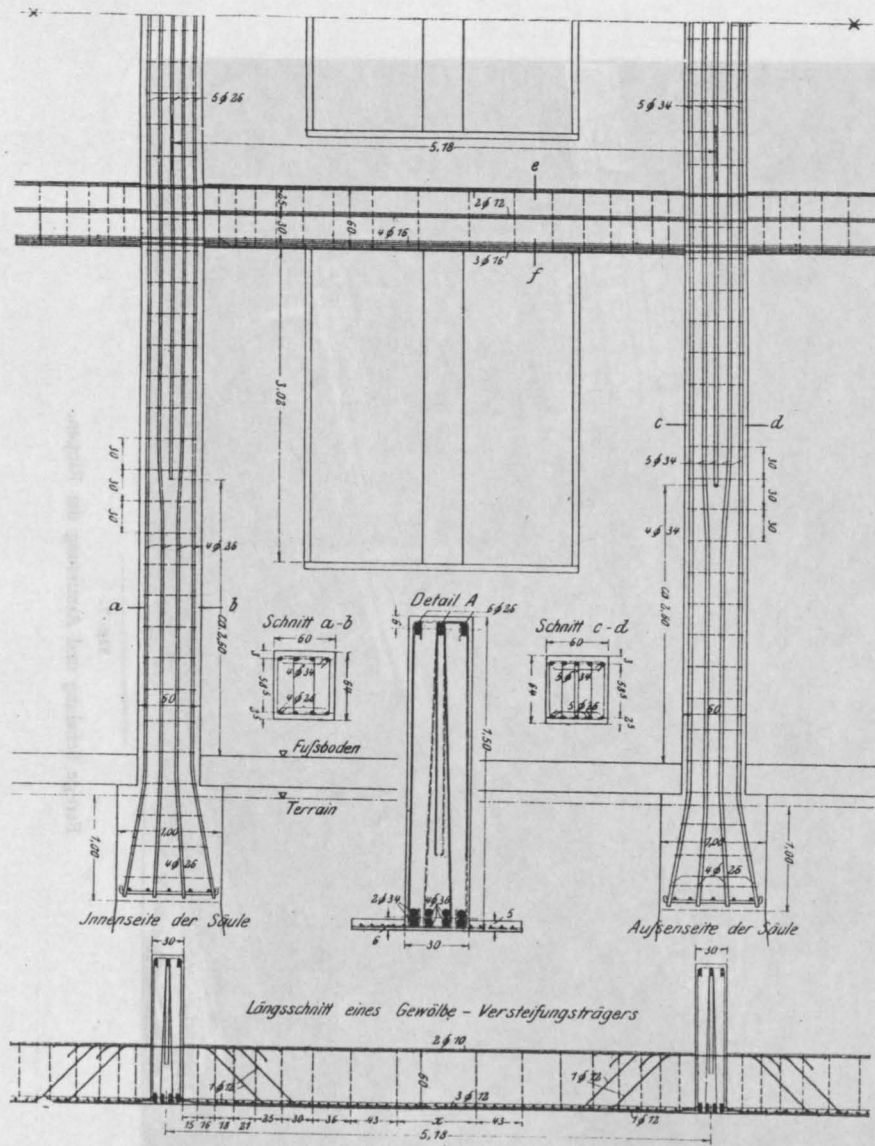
Längsschnitte mit Detailkonstruktionen.
